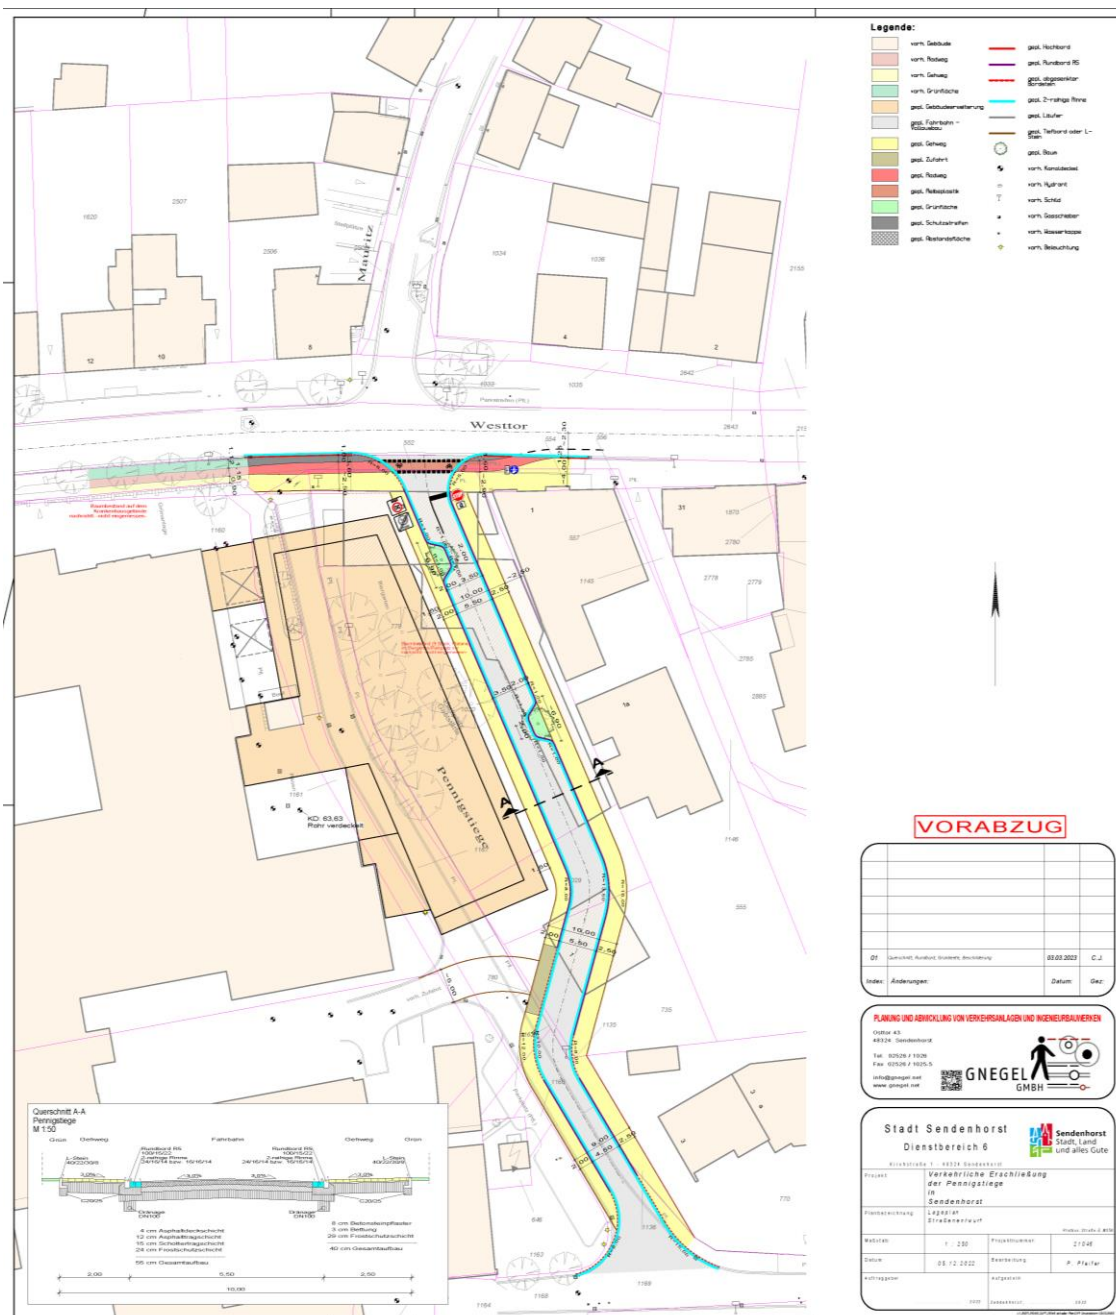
Verkehrliche Erschließung der Pennigstiege, Lageplan Straßentwurf Erläuterungsbericht und Lageplan, Gnegel GmbH, Sendenhorst, Stand 01.12.2022 mit Anlage 1 Lageplan Straßentwurf, geändert am 03.03.2023 ▲ Nord
